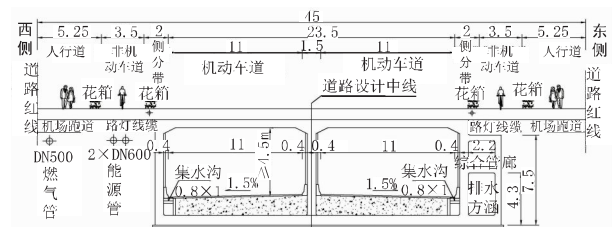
下穿式隧道暗埋段横断面布置图(单位:m)
